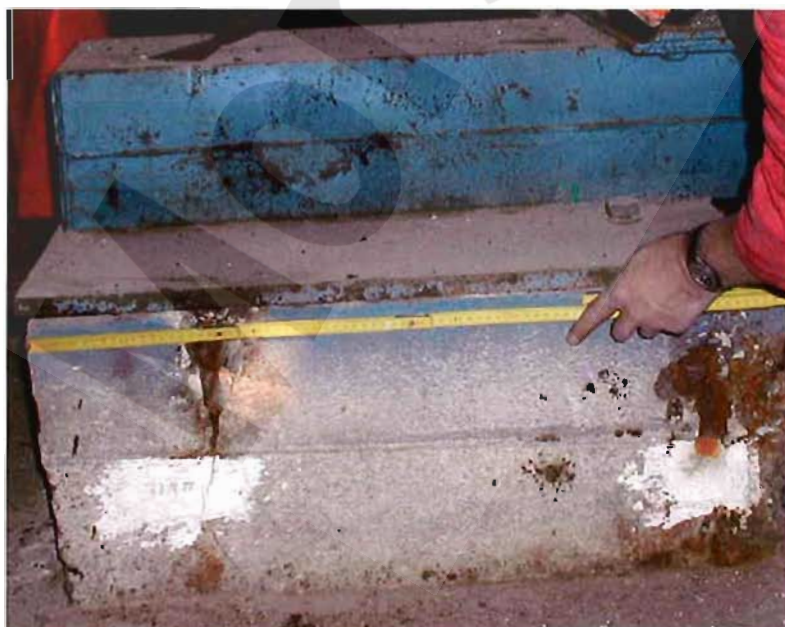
Schacht Bartensleben Füllortkeller -372 mNN Sohle -NW- vertikaler Riss im Schachtstuhlfundament
